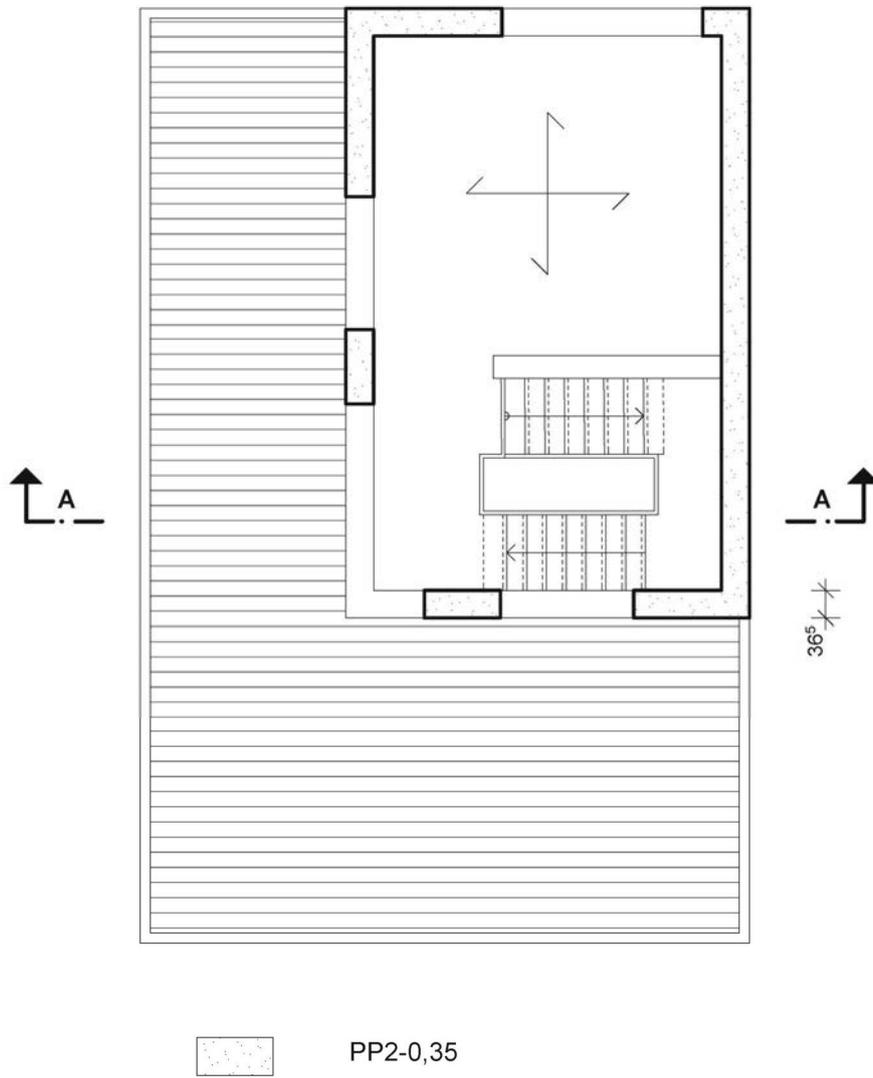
Einfamilienhaus in Berlin, Grundriss Staffel-/Dachgeschoss
